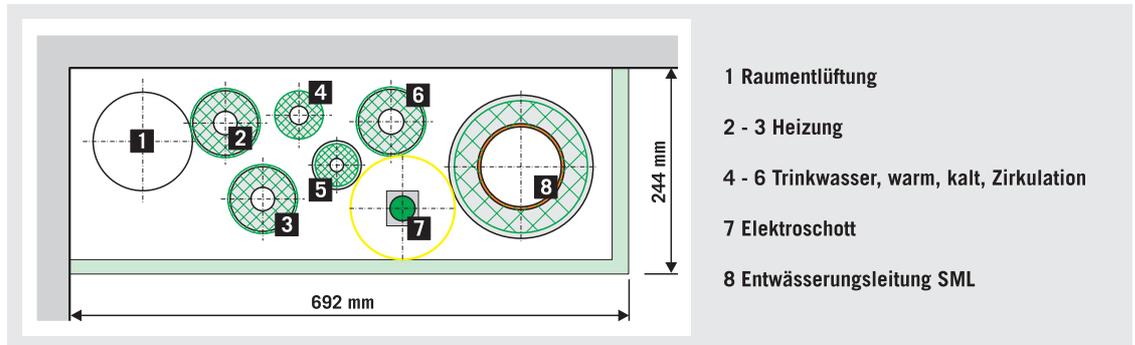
Planungsbeispiel einer „Sammeldurchführung“
